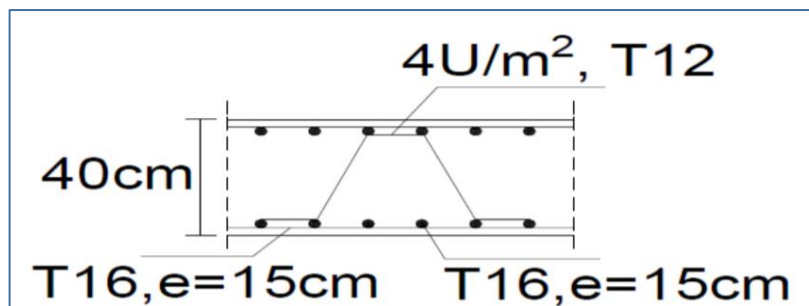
Ferrailage de la dalle du radier en appuis.
